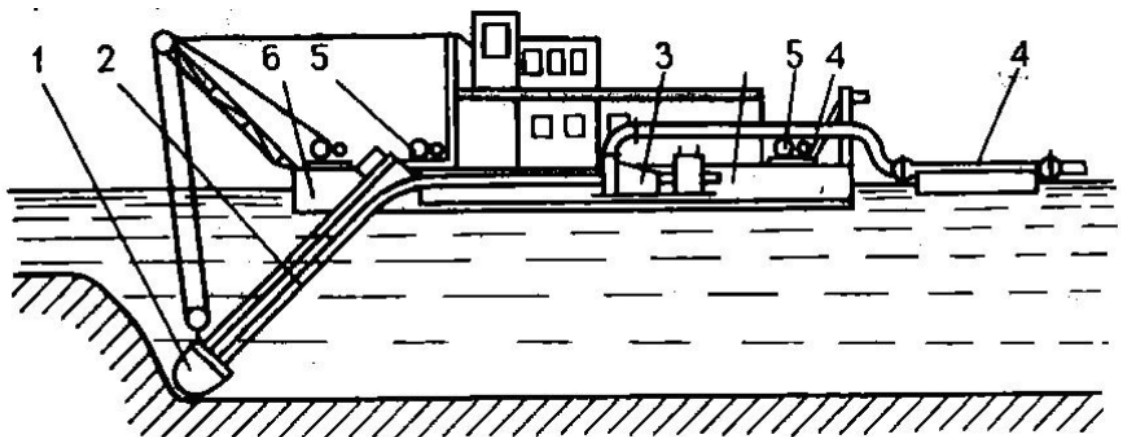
Принципиальная схема землесосного снаряда. 1 - грунтозаборное устройство; 2 - всасывающий трубопровод; 3 - грунтовый насос; 4 - напорный трубопровод; 5 - устройство для рабочих перемещений; 6 — корпус.
